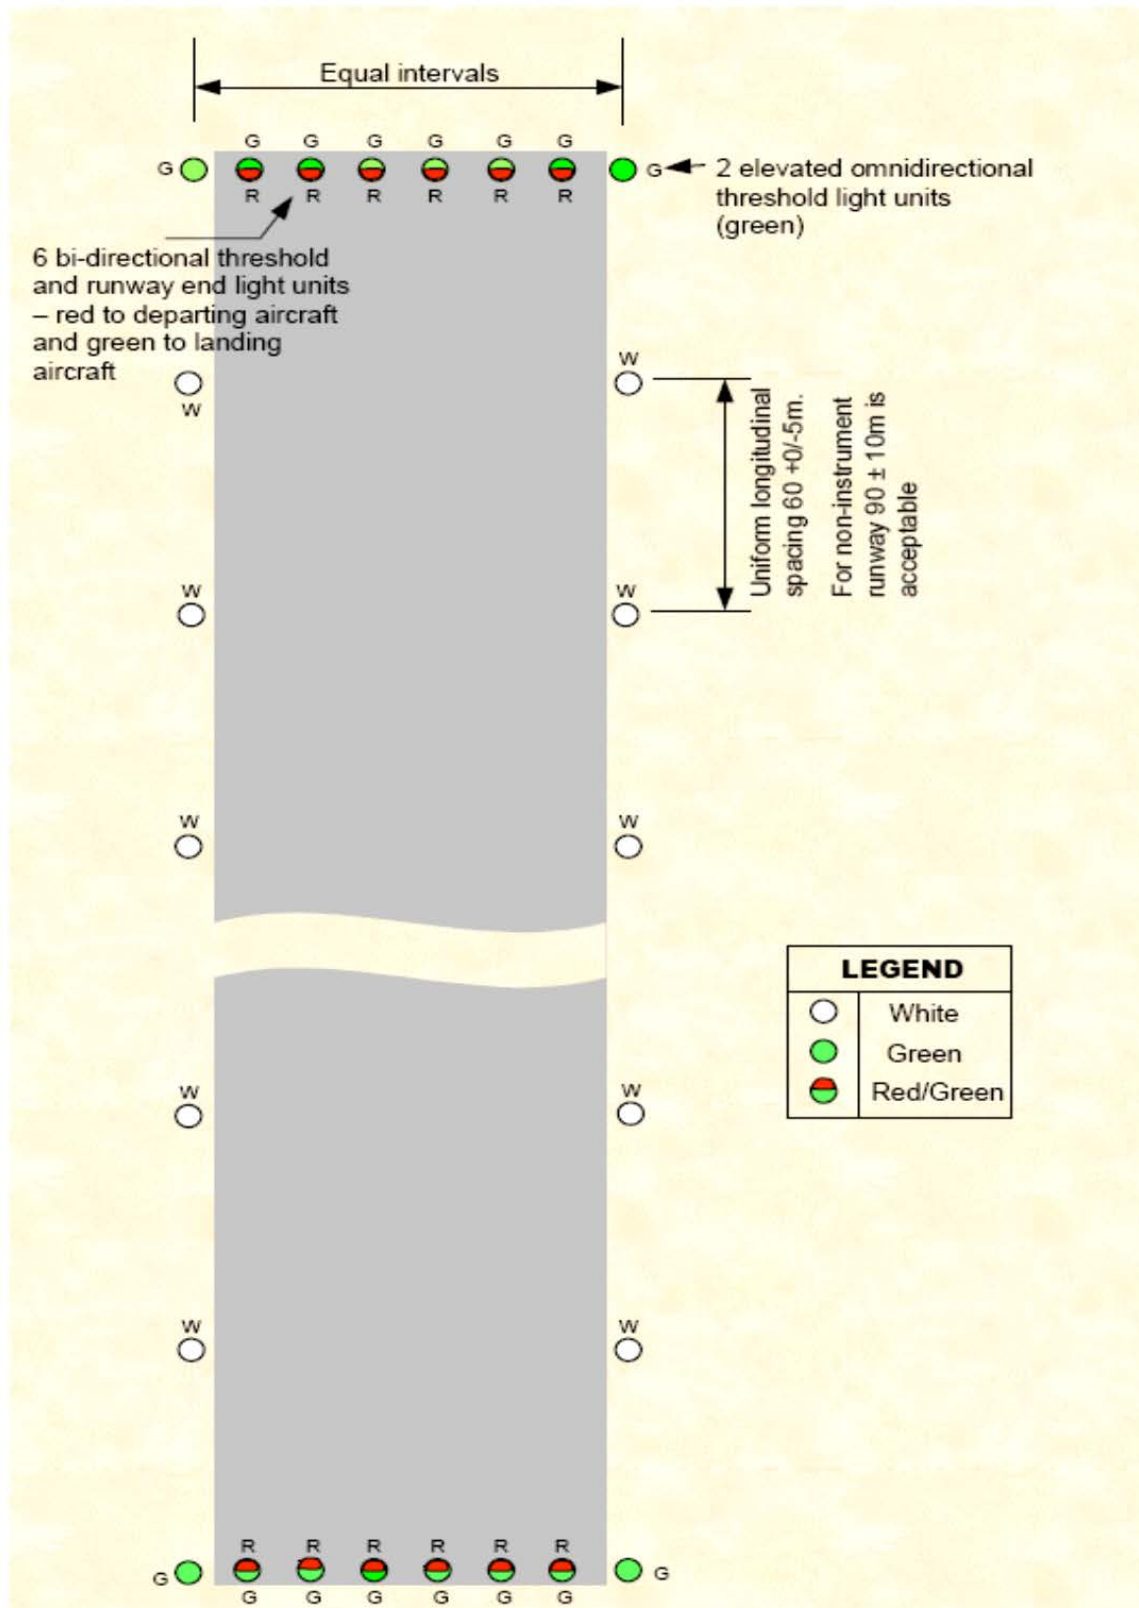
Konfigurasi lampu runway edge untuk runway lebar 45 m
